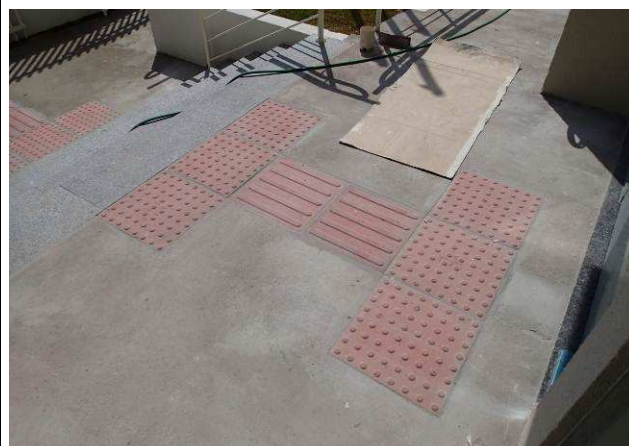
C: Placas cimentícias de piso podotátil instaladas no passeio e área externa.
